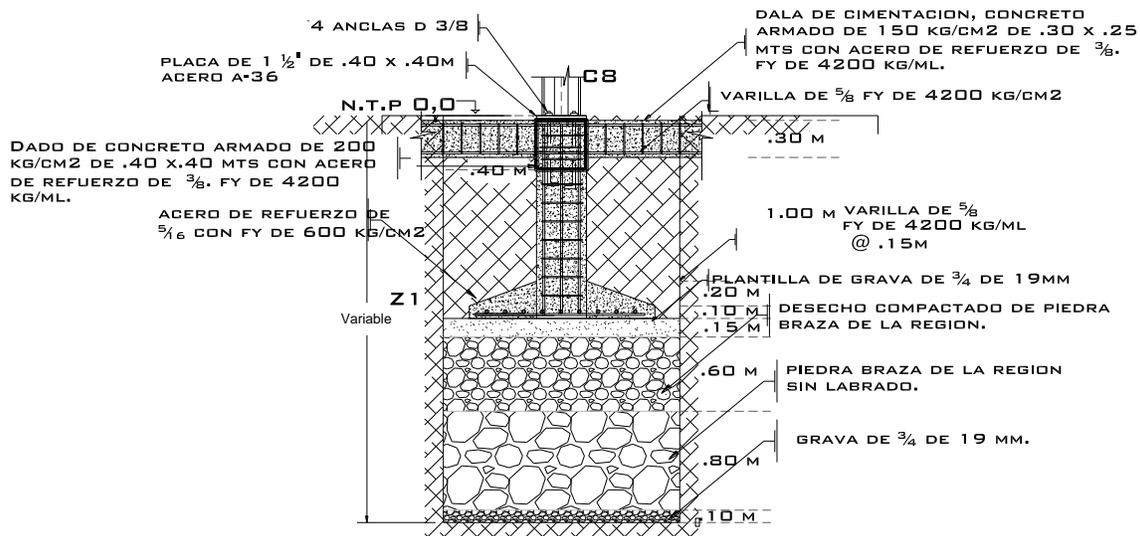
, Detalle de Mejoramiento de terreno, Diseño de Cimentación: Hugo Orduña.
